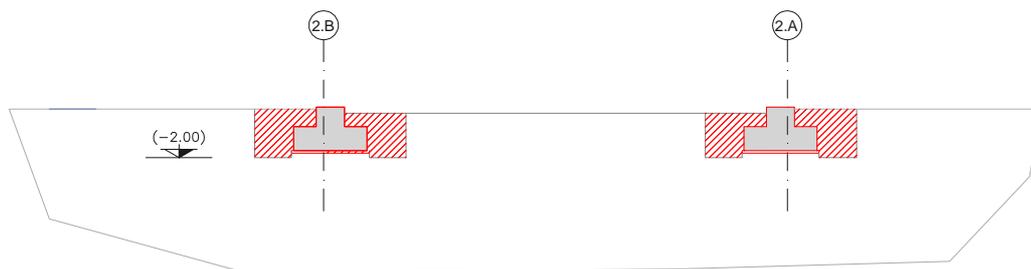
Scavo trincee di accesso a sezioni periferiche (travi rovesce) fondazione
